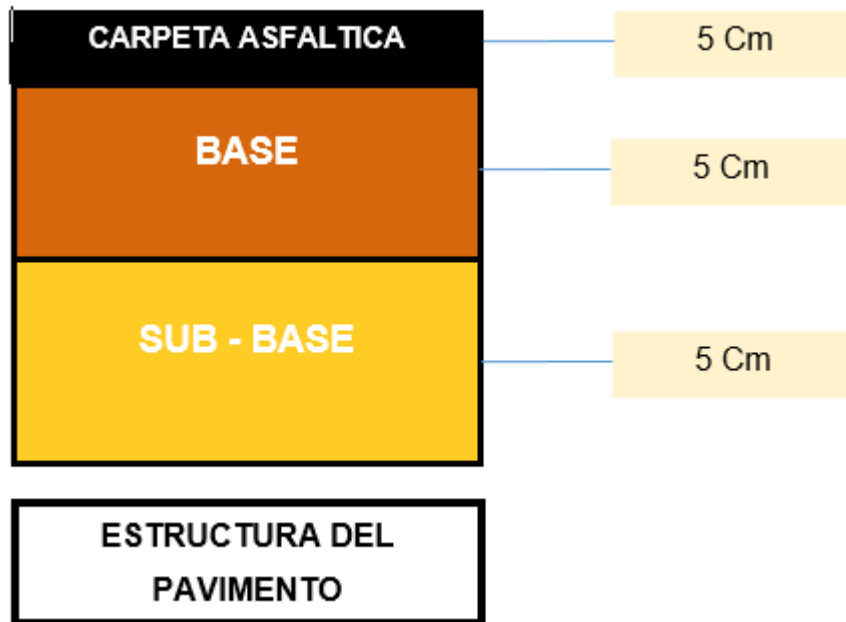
Capas que conforman la estructura de un pavimento flexible.
